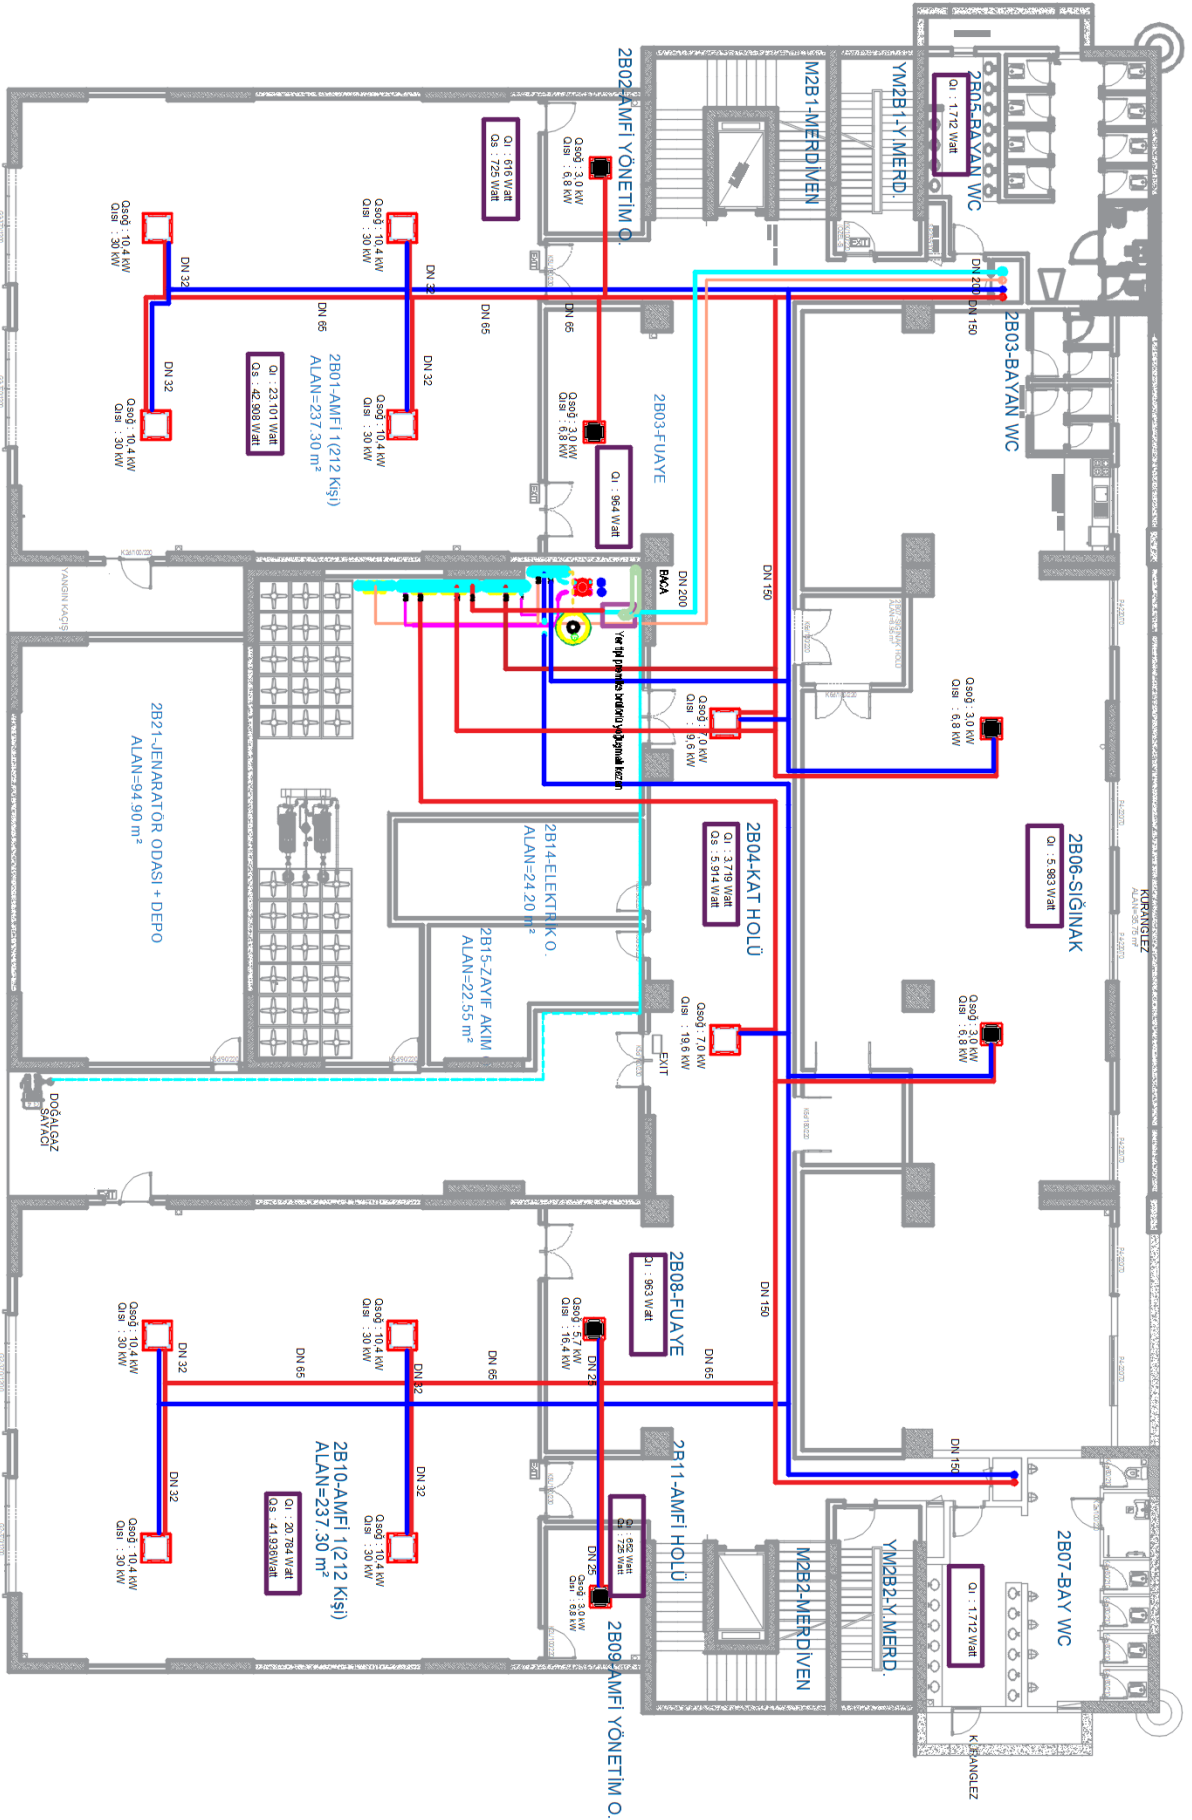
VRF tesisatı Sistem 3 grubuna ait kolon şeması.
